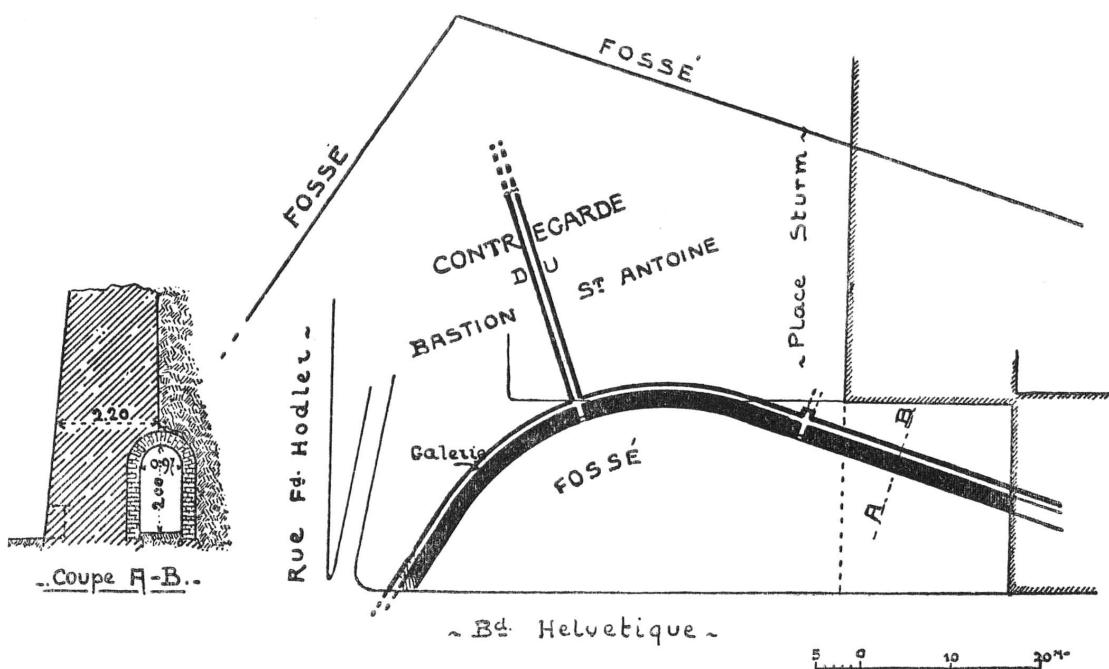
Plan et coupe de la galerie de mines de la contregarde de Saint-Antoine.
